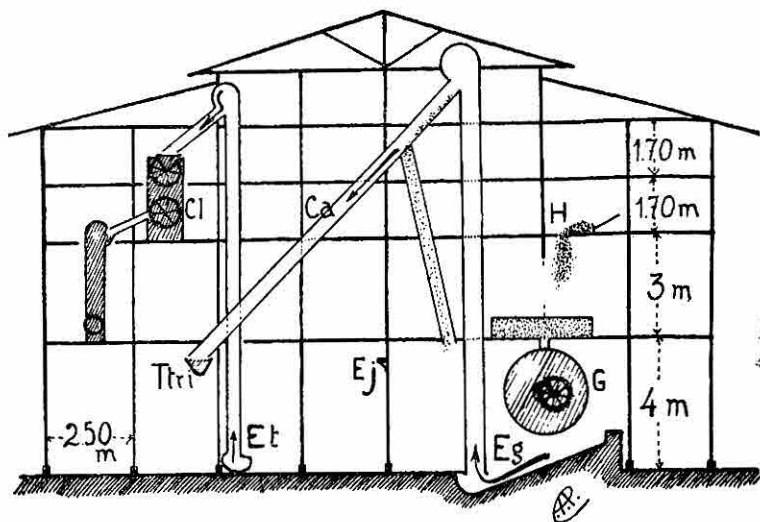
Tercer tipo de instalación: alzada. Ca, canal de descenso hacia la trilladora desde el elevador de la guardiola; Cl, clasificadora; Ej, eje de transmisión; Eg, elevador de la guardiola; Tt, elevador de trillado; G, guardiola u Okrassa; H, hoyo para descargar café de un piso a otro; Tri, tolva de la trilladora. El café circula así en el edificio: tolva de la descereziadora, tanques de fermentación, lavadora, escurridor, elevador de húmedo, cajones de la guardiola, elevador de la guardiola que lleva inmediatamente a la trilladora o por un canal que aparece en la figura, lo descarga al depósito de café de trilla para tomarlo de nuevo cuando sea tiempo de trillar-lo. Después seguirá este camino: trilladora, elevador de la trilladora, clasificador, catador, cuarto de empaques.
